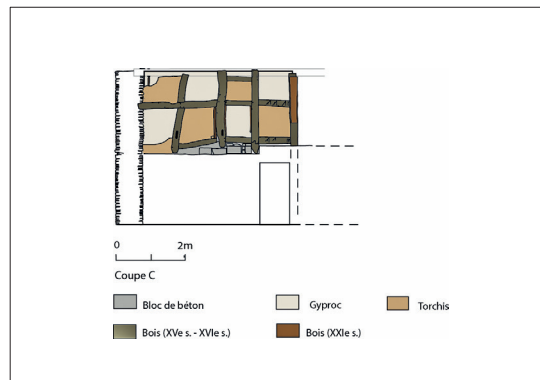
Relevé du mur est du logis (coupe C, voir plan - fig. 7).
